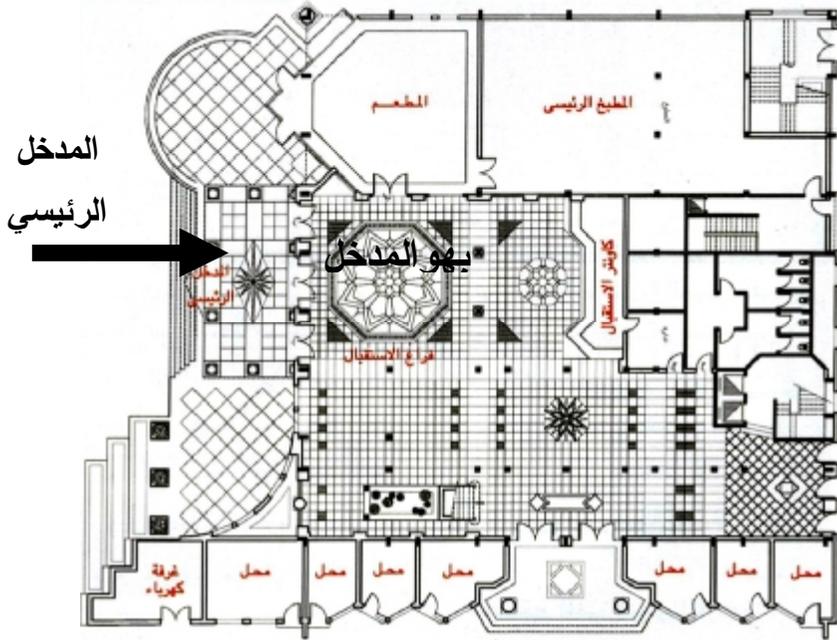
مسقط أفقي للدور الأرضي للمبنى الفرعوني دار المركبات.
